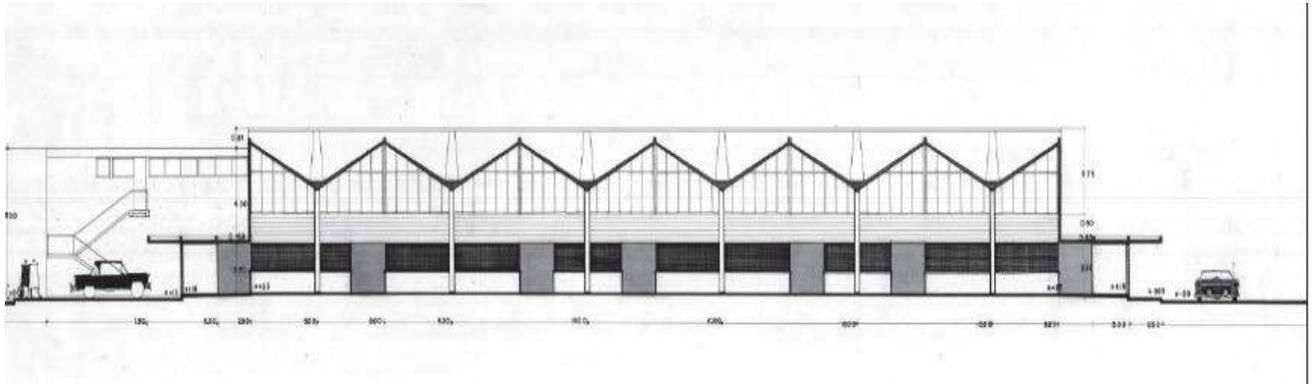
Corte longitudinal por salas de ventas, archivo de Arquitectos Mexicanos, Fondo Pedro Ramírez Vázquez, *op. cit.
